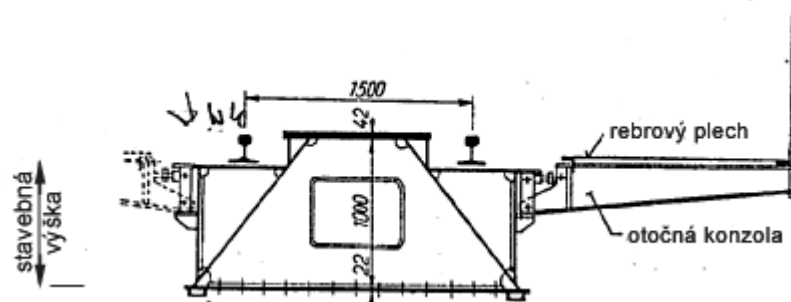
Príklad priečného rezu železničného mosta s hornou mostovkou (viď tiež obr. 4.3a,b)
